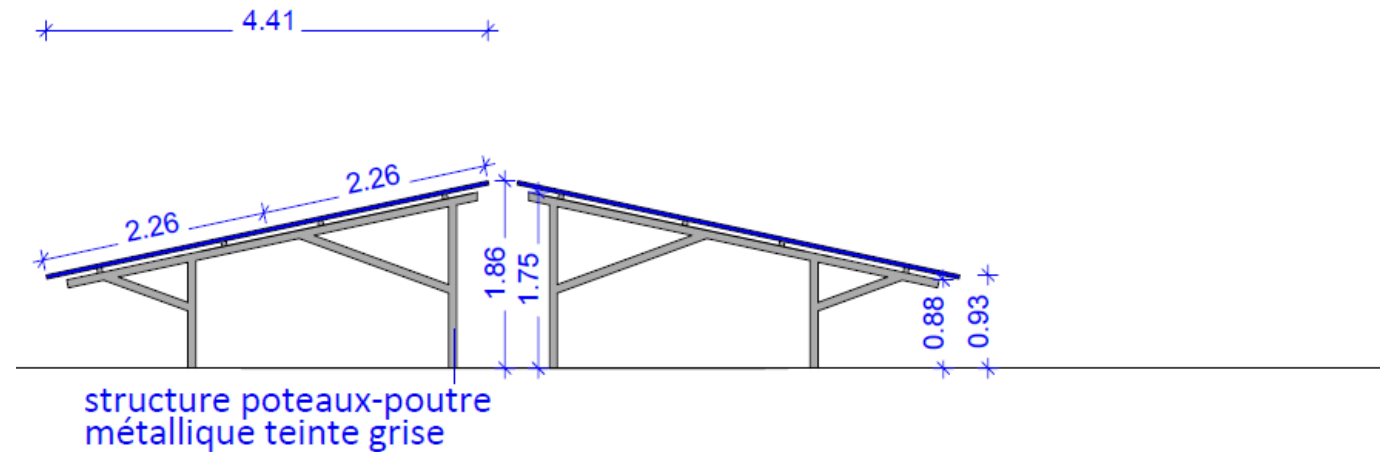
Plan de principe des façades Nord et Sud (Source : Permis de construire du projet, mai 2022)
